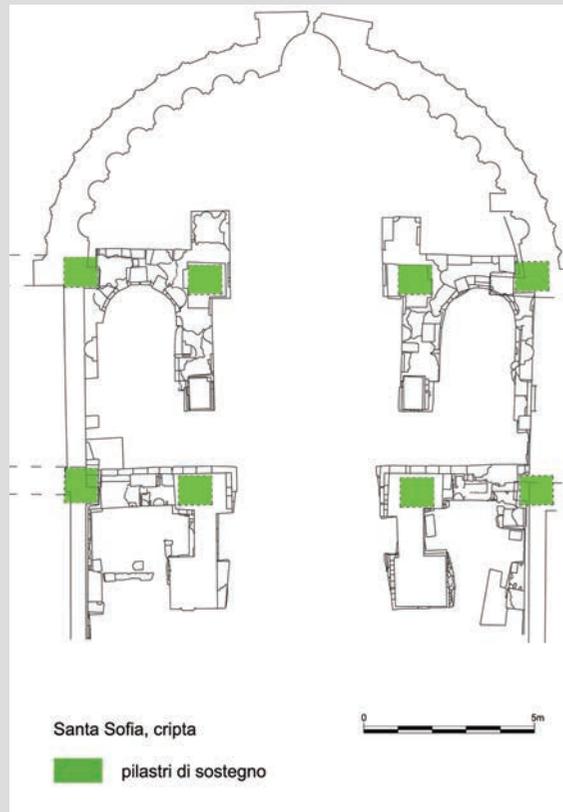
Santa Sofia: planimetria della cripta con evidenziati i probabili pilastri di sostegno della cupola del transetto e del tiburio.
